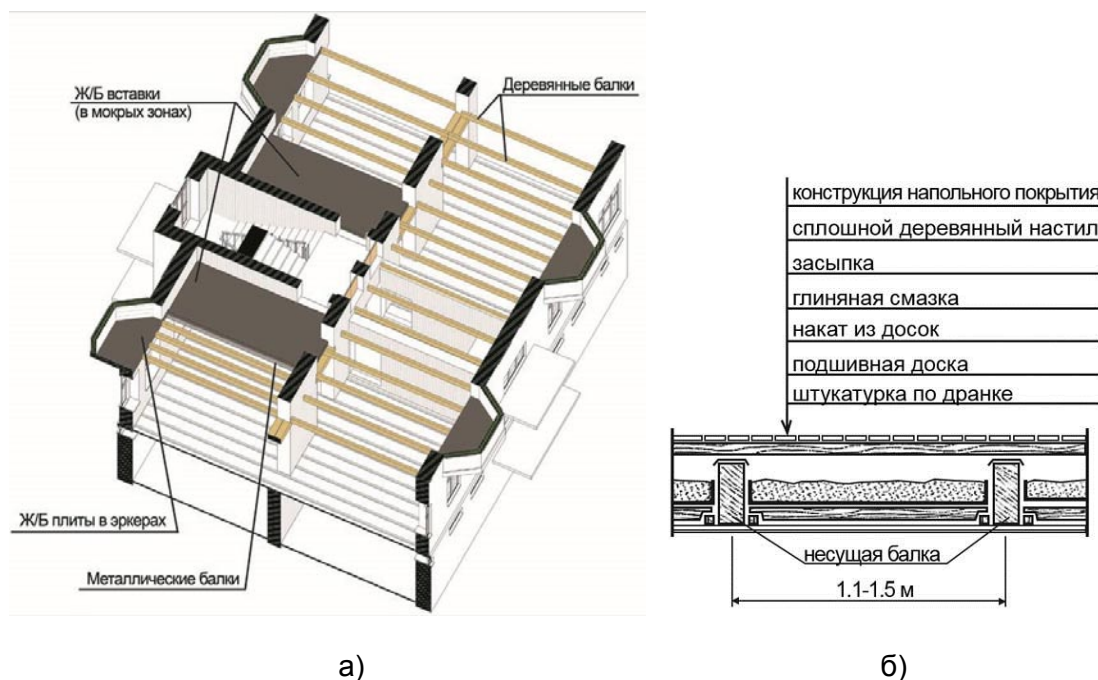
Конструкция перекрытия в жилых корпусах «Городка чекистов»: а) схема раскладки балок; б) предположительный состав перекрытия
